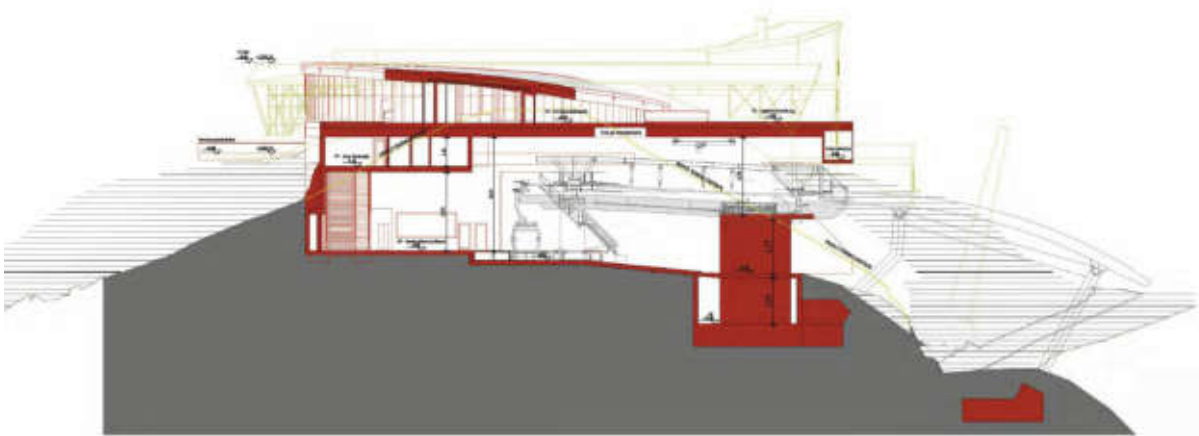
Projektauszug –Schnitt AA – GR -M Bergstation (Arch. Sader) / stralcio da progetto – sezione AA – GR -M stazione di monte (Arch. Sader)
